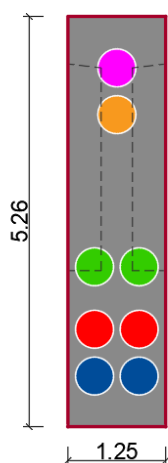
Secção transversal das vigas pré-esforçadas na zona do apoio
